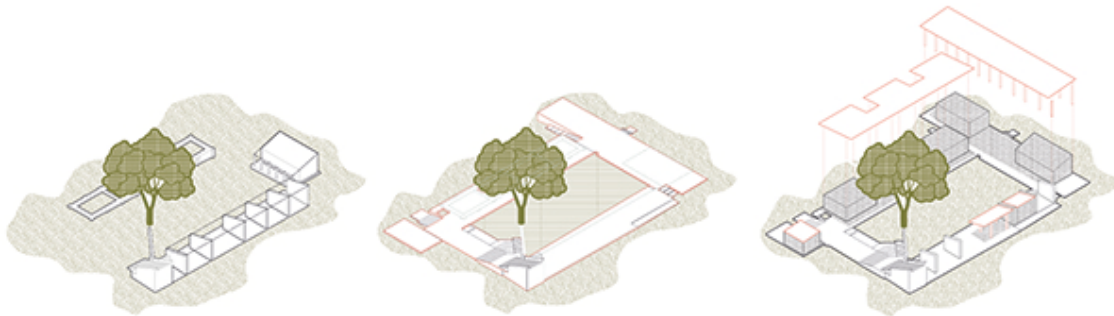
Jardín de infantes. Elementos primarios de construcción: planos horizontales (basamento y cubierta) y vertical (márgenes murales). Elaboración propia.
